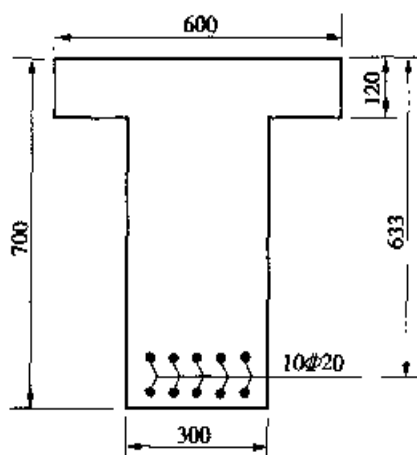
T 形梁截面尺寸及配筋 (尺寸单位: mm)
